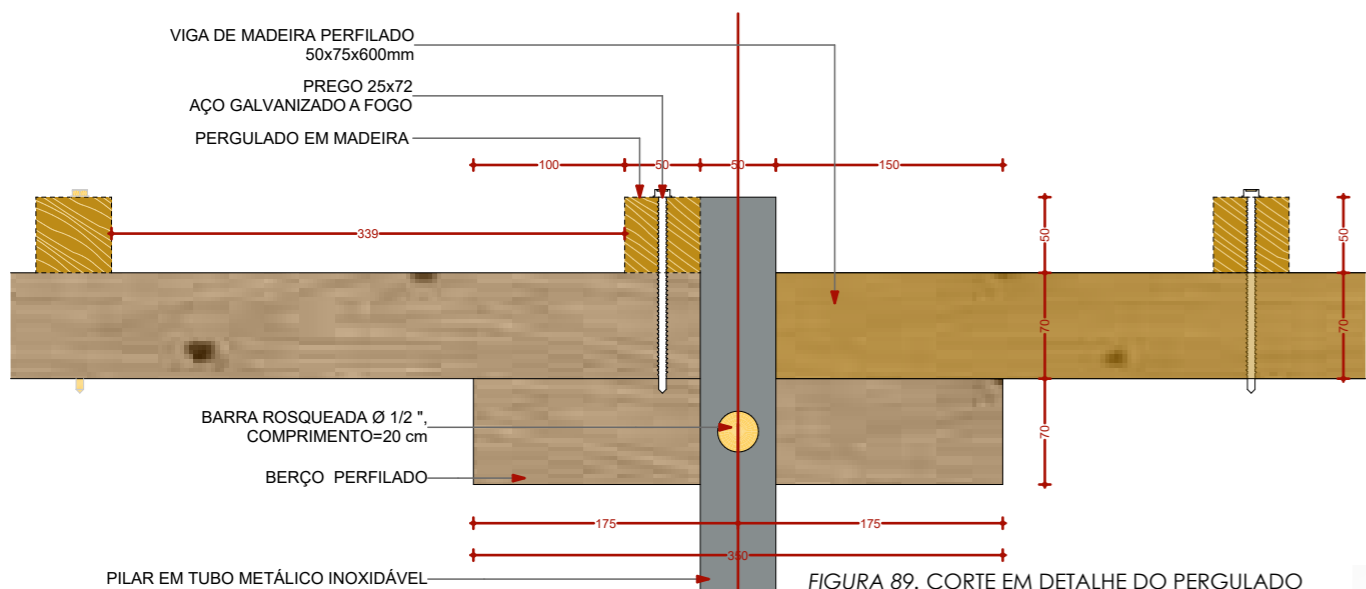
CORTE EM DETALHE DO PERGULADO ESC. 1/5 fonte: Autor
